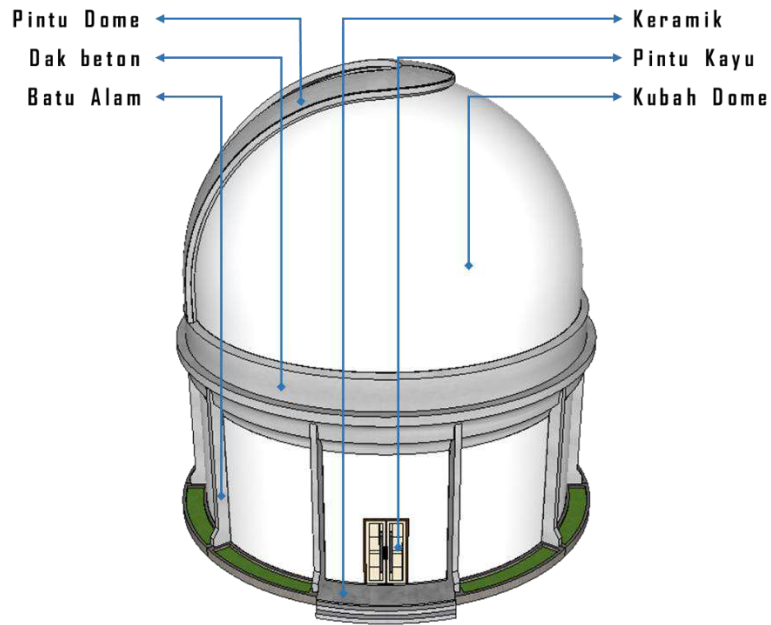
29 : Konsep Material Pada Atap & Façade Bangunan
